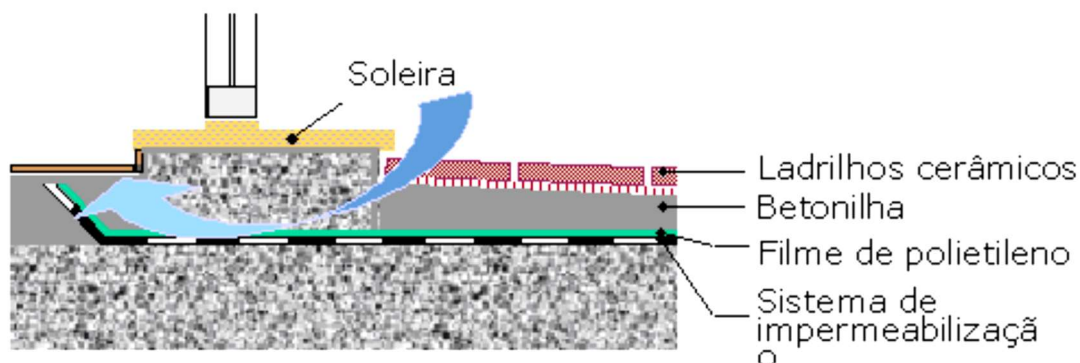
Possível pormenor construtivo da impermeabilização na soleira
